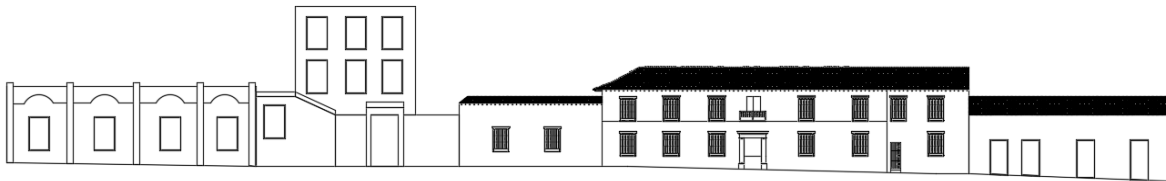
, Fachada principal de la Casona (carrera 4), Fuente: Autor propio, 2016.
